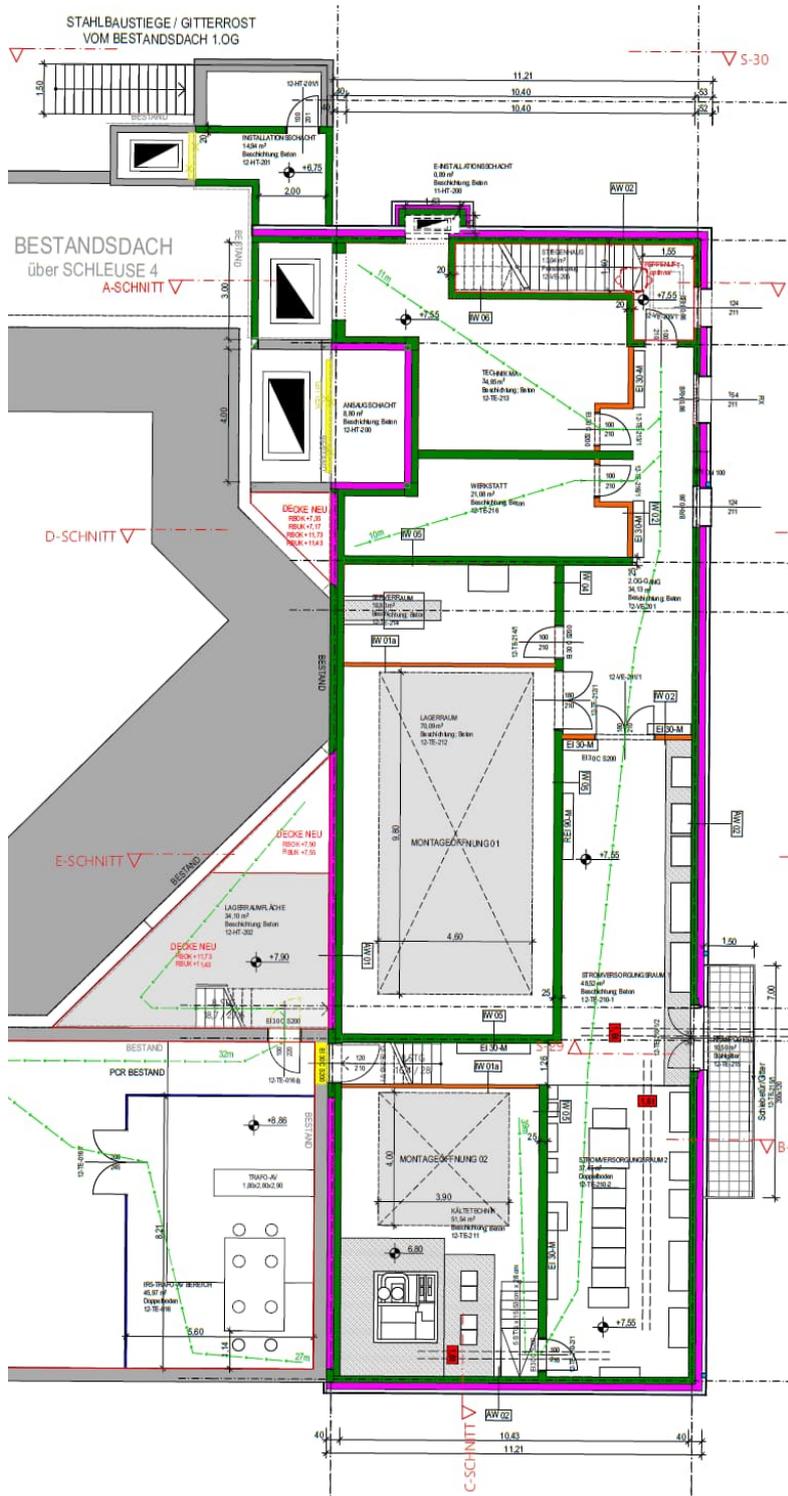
2. Obergeschoss. Details können dem Plan „B.03-01 P02 2.0 A Grundriss 1. Obergeschoss und 2. Obergeschoss inkl. Dachdraufsicht“ entnommen werden.
